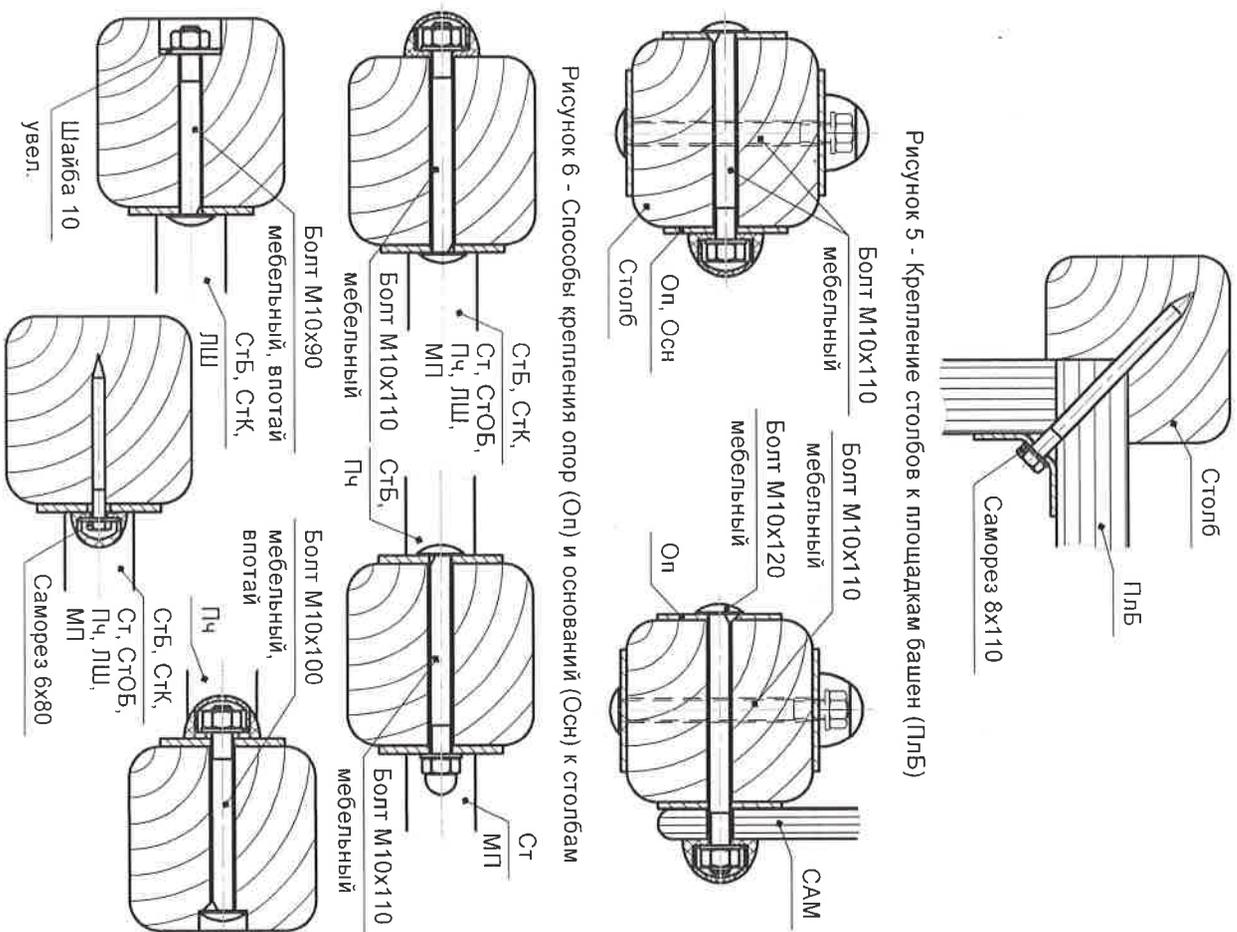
Крепление столбов к площадкам башен (Плб)
